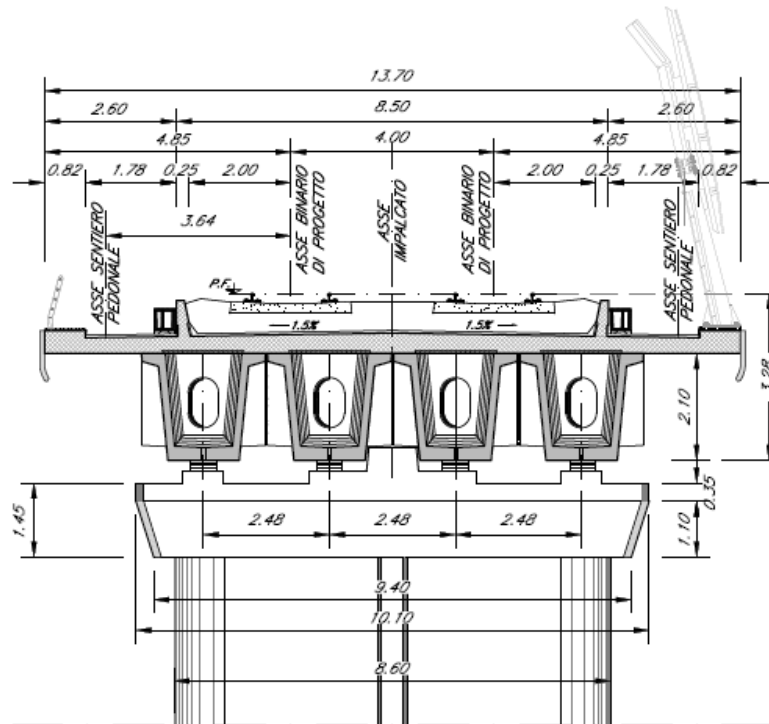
Stralcio sezione tipo su opera d'arte: viadotto a struttura isostatica cap
